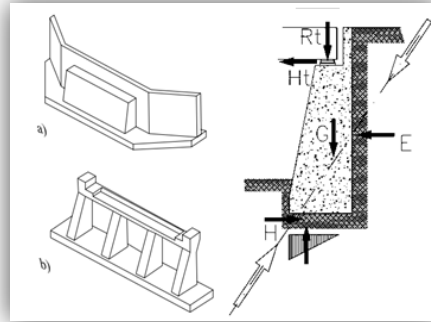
a) Estribo de gravedad con aletas, b) Estribo con contrafuertes. Esquema de fuerzas sobre estribo
